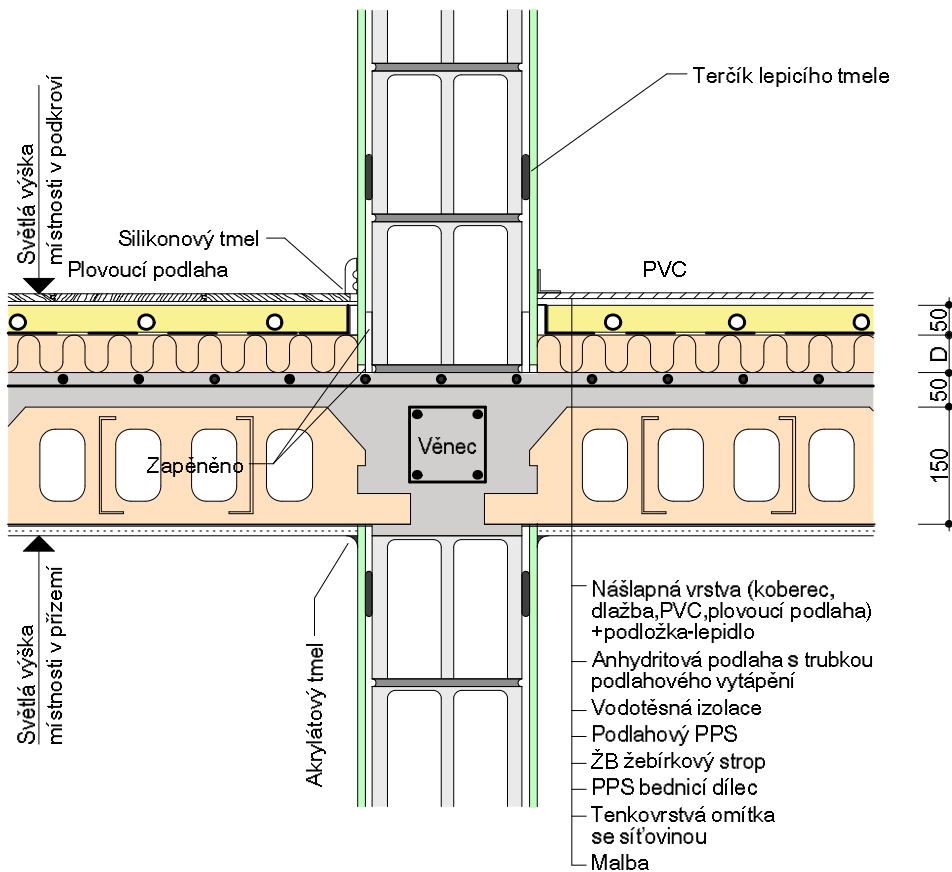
STYK PŘÍČKY A PODLAHY, ŘEZ b-b'
